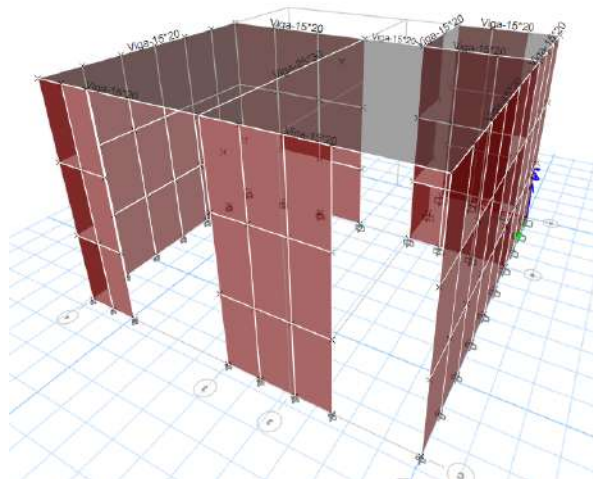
Vista en planta del modelamiento de la vivienda 11
